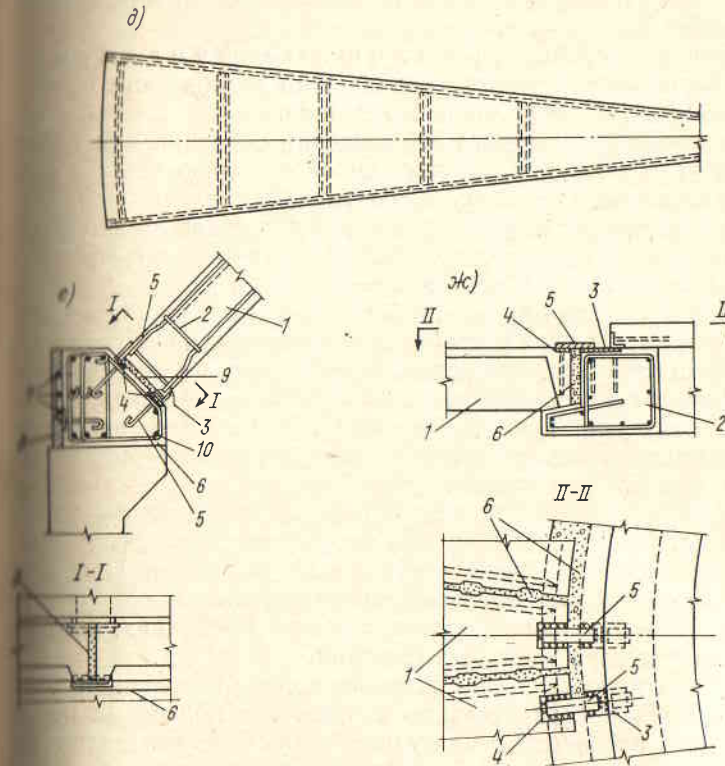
Детали армирования монолитных железобетонных куполов-оболочек
